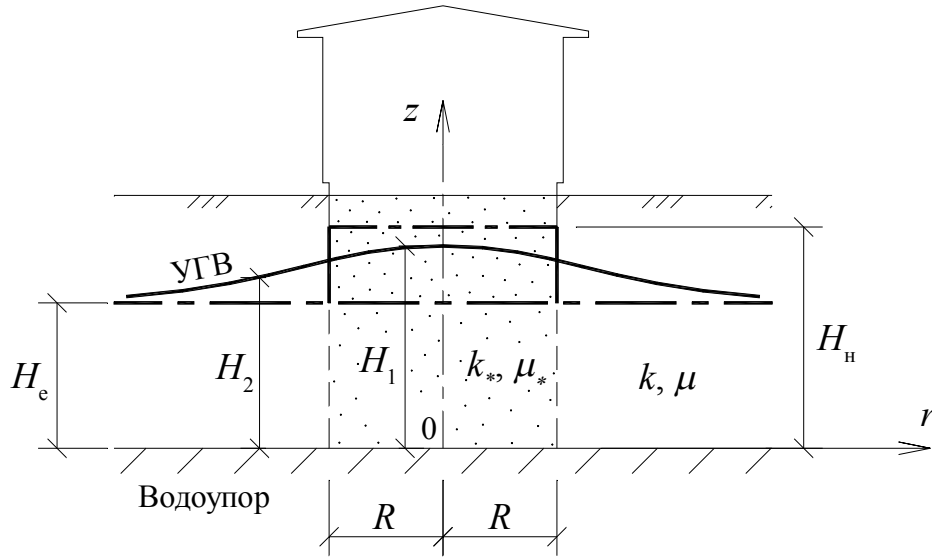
Растекание круглого в плане купола грунтовых вод в основании здания или сооружения
